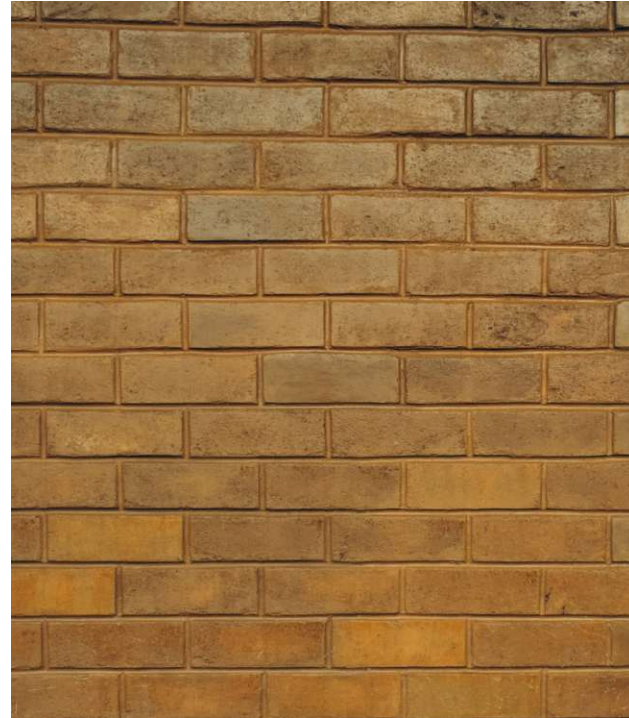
Mauerwerk mit ISSB-Ziegeln und Murram-Mörtel
